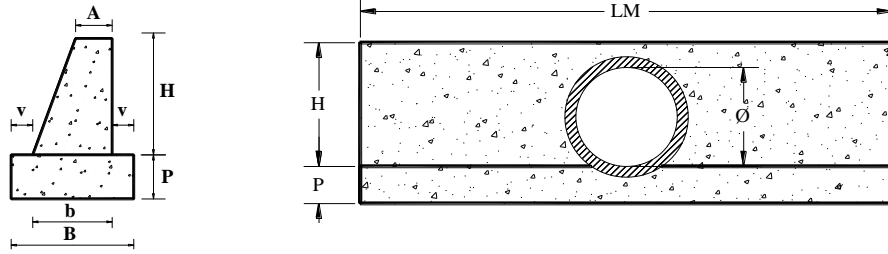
Proyectos tipo de corte longitudinal de alcantarilla tubular y cabezote de concreto
